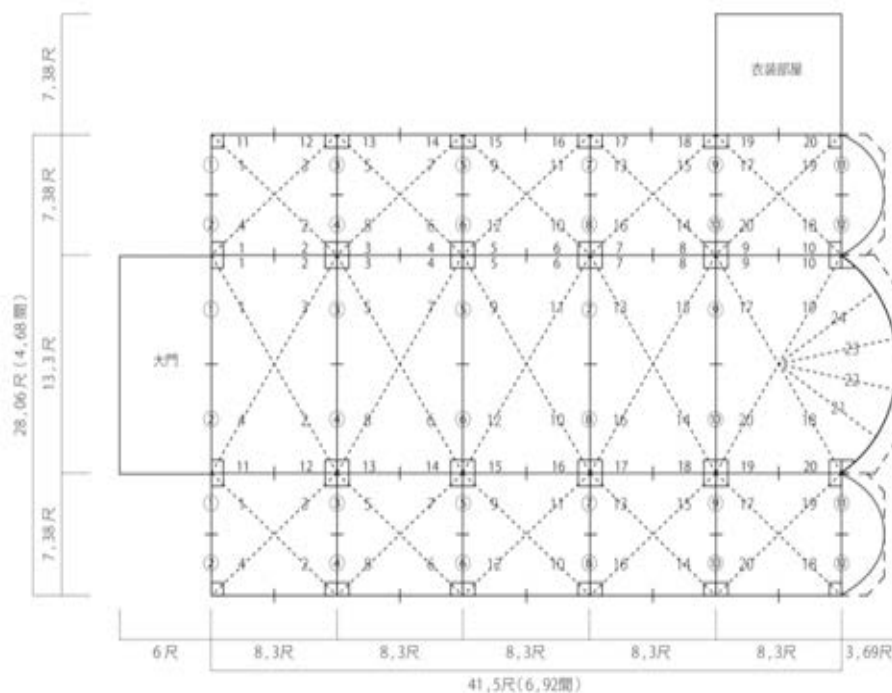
改修工事前の桐古天主堂 復元イメージ図 平面図
